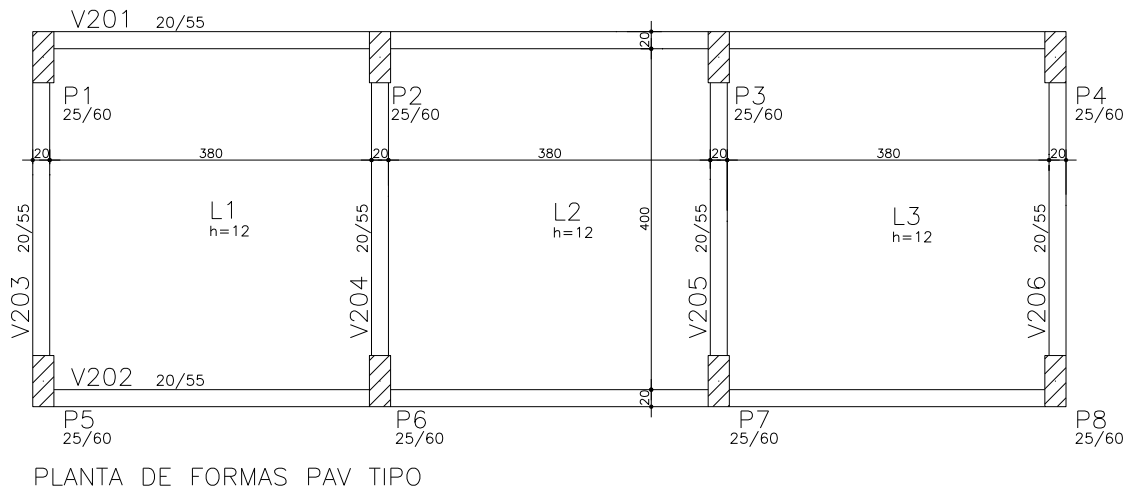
Planta de formas do pavimento tipo: T1 -3P2V2
